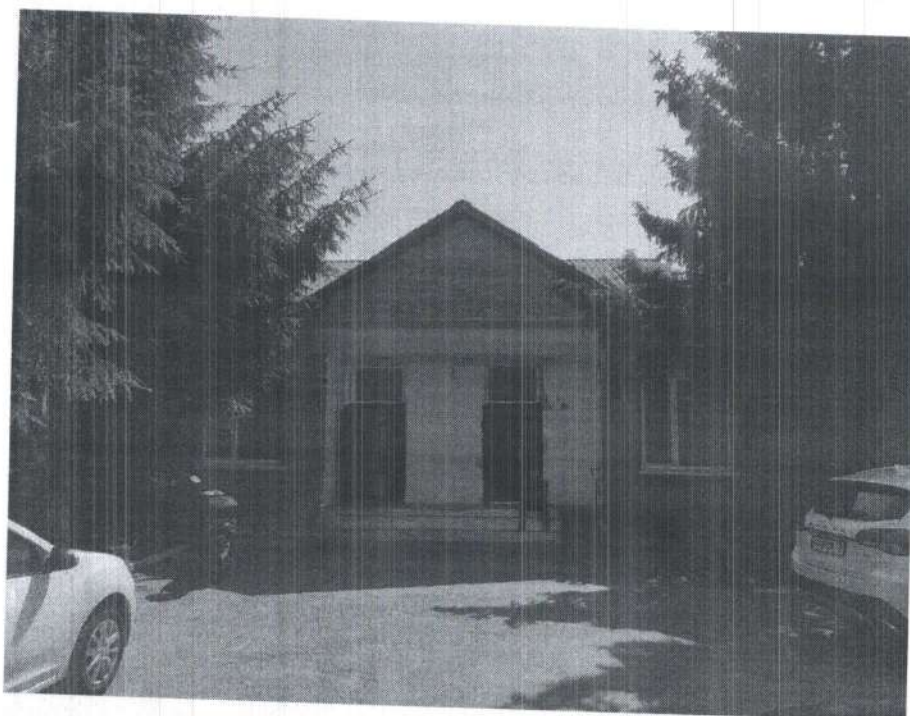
Фасад 3-6 (головний вхід в будівлю)
